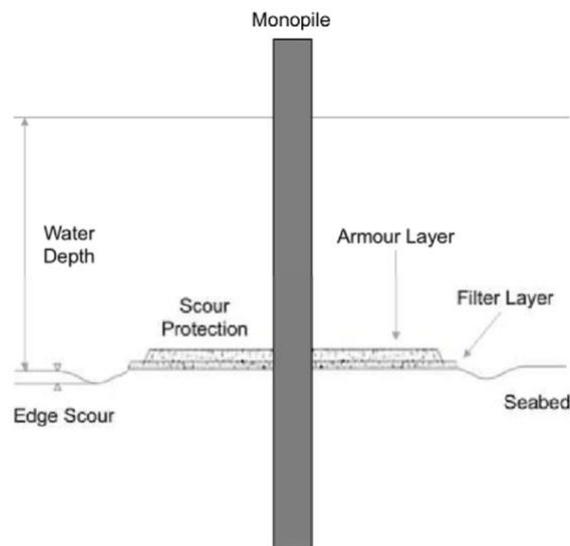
Schematizzazione del sistema di protezione anti scouring mediante armatura in roccia
